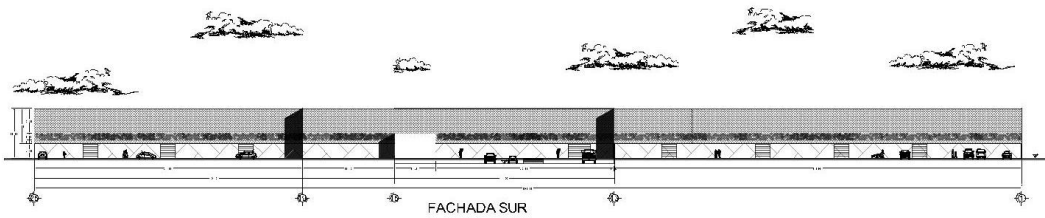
Propuesta de Fachada Vista Sur, Mercado Independencia
